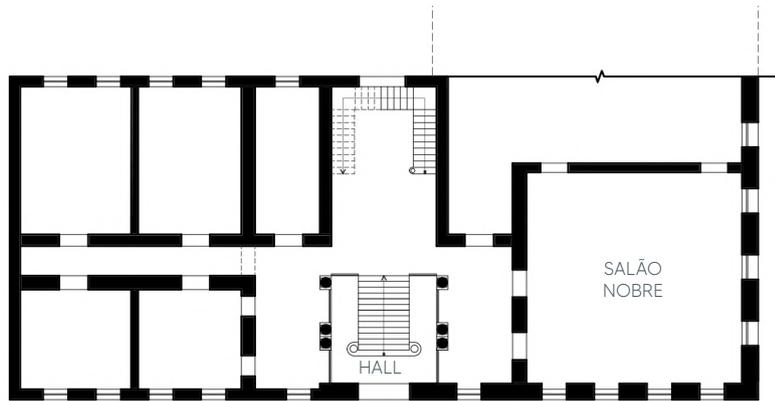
Redesenho do trecho da planta do 1º pavimento.²⁰⁰
